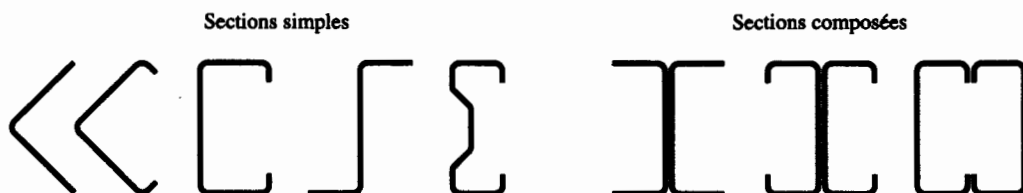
Exemples de quelques types de section de profils à parois minces.
